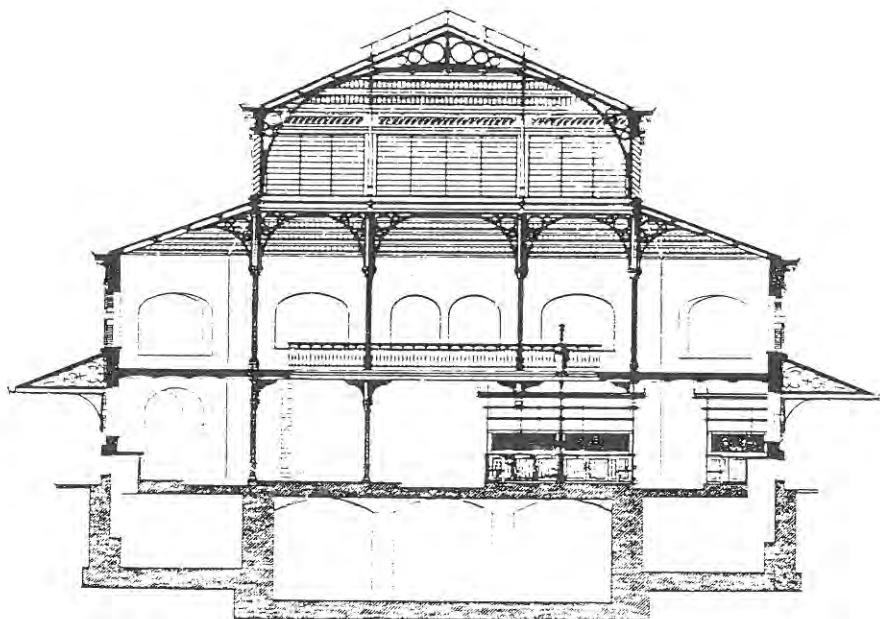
Coupe transversale. Plan paru dans «L'Emulation» 1882-1883 (Inter-Environnement Bruxelles, *Le marché Saint-Géry, proposition de reconversion en hôtel artisanal*, 1983, p. 117).
